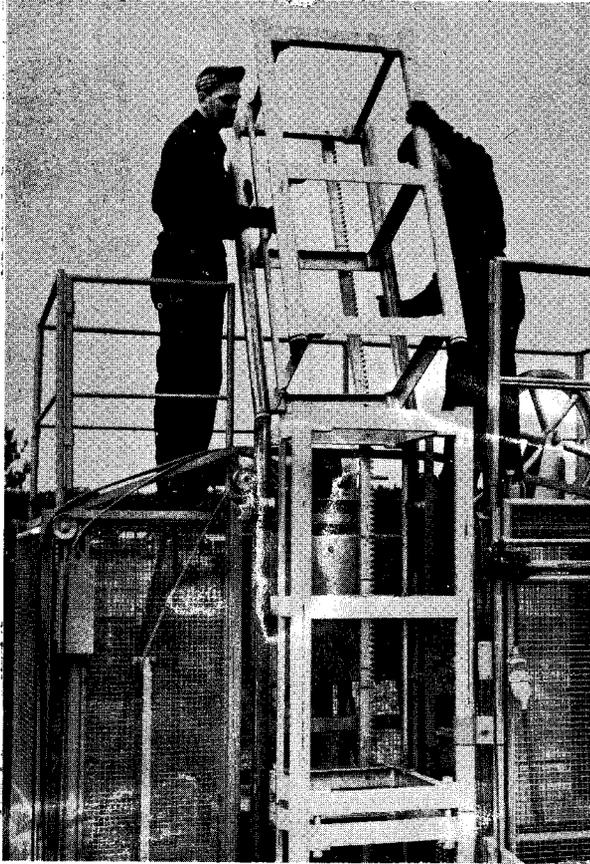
Vista demostrando la colocación de una sección adicional de torre.
